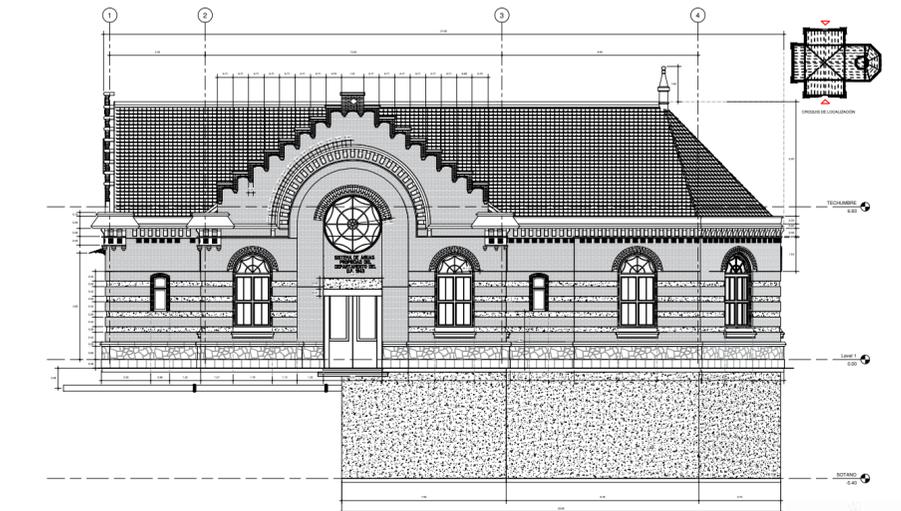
Fachada arquitectónica tipo. Producción colectiva MRPE.
